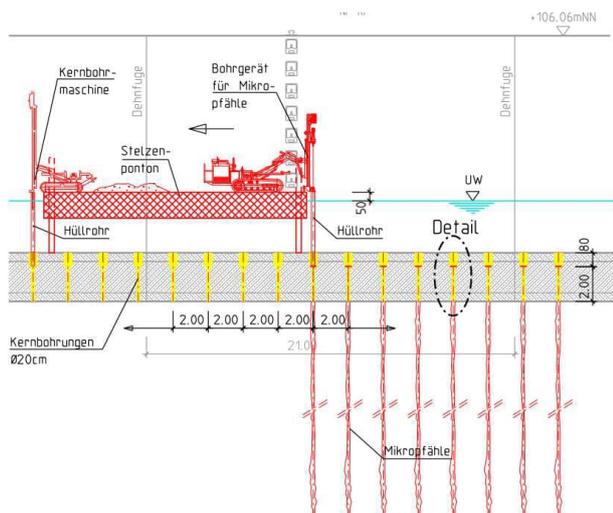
Längsschnitt Kammersole – Einbau Auftriebssicherung
